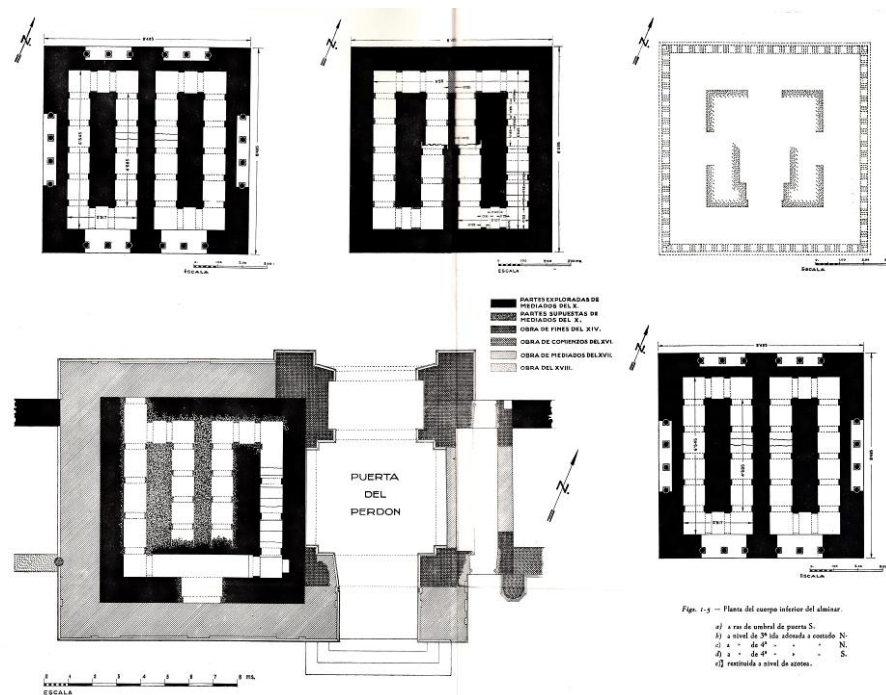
Planos de Planta de la restitución propuesta (Hernández Giménez, 1975).
